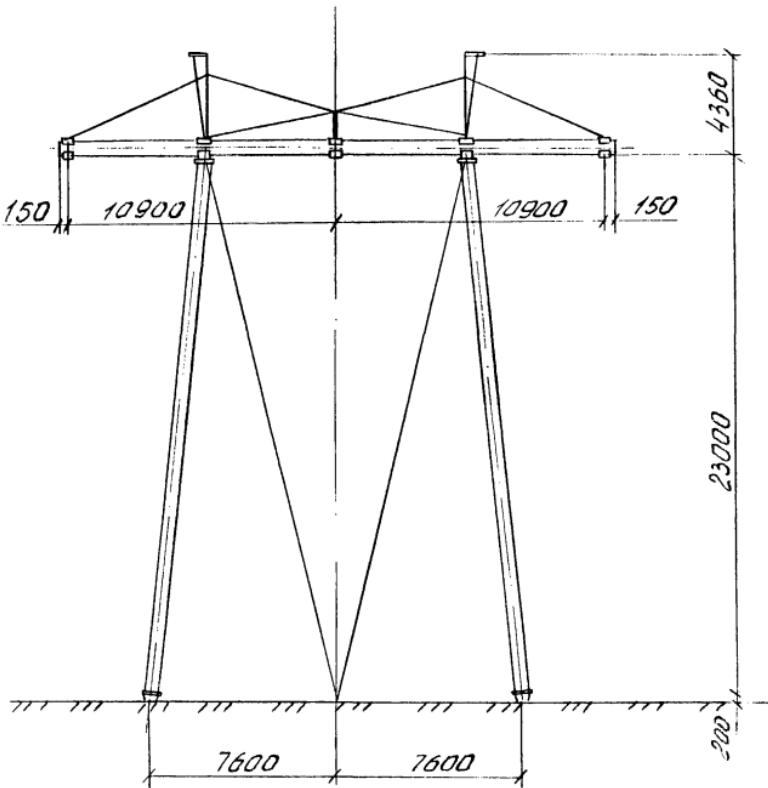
Промежуточная железобетонная опора типа ПБ-500-1
